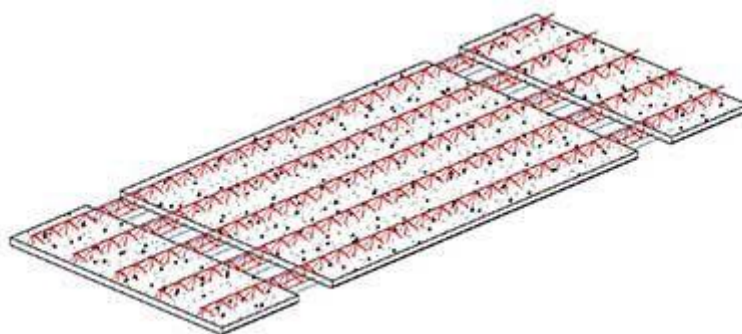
Esquema de las prelasas a utilizar para la construcción del tablero.
